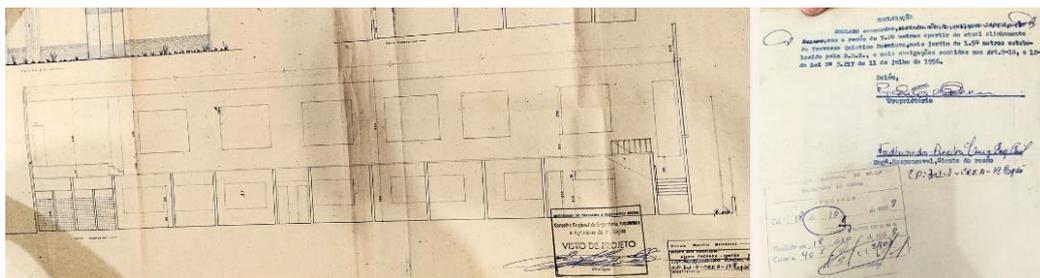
Planta Baixa de anexo ao COB com assinatura de projeto. Fonte: Círculo Operário Belemense, dec. 60.
